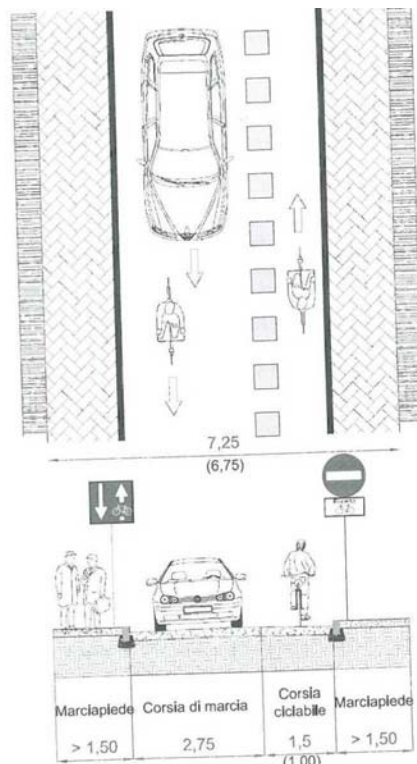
Esempio di pianta e sezione in centro storico con pista in controsenso
